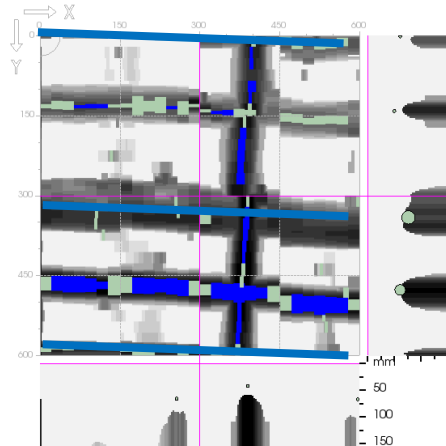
Poutre Pt03 – Travée 2 à mi-travée
